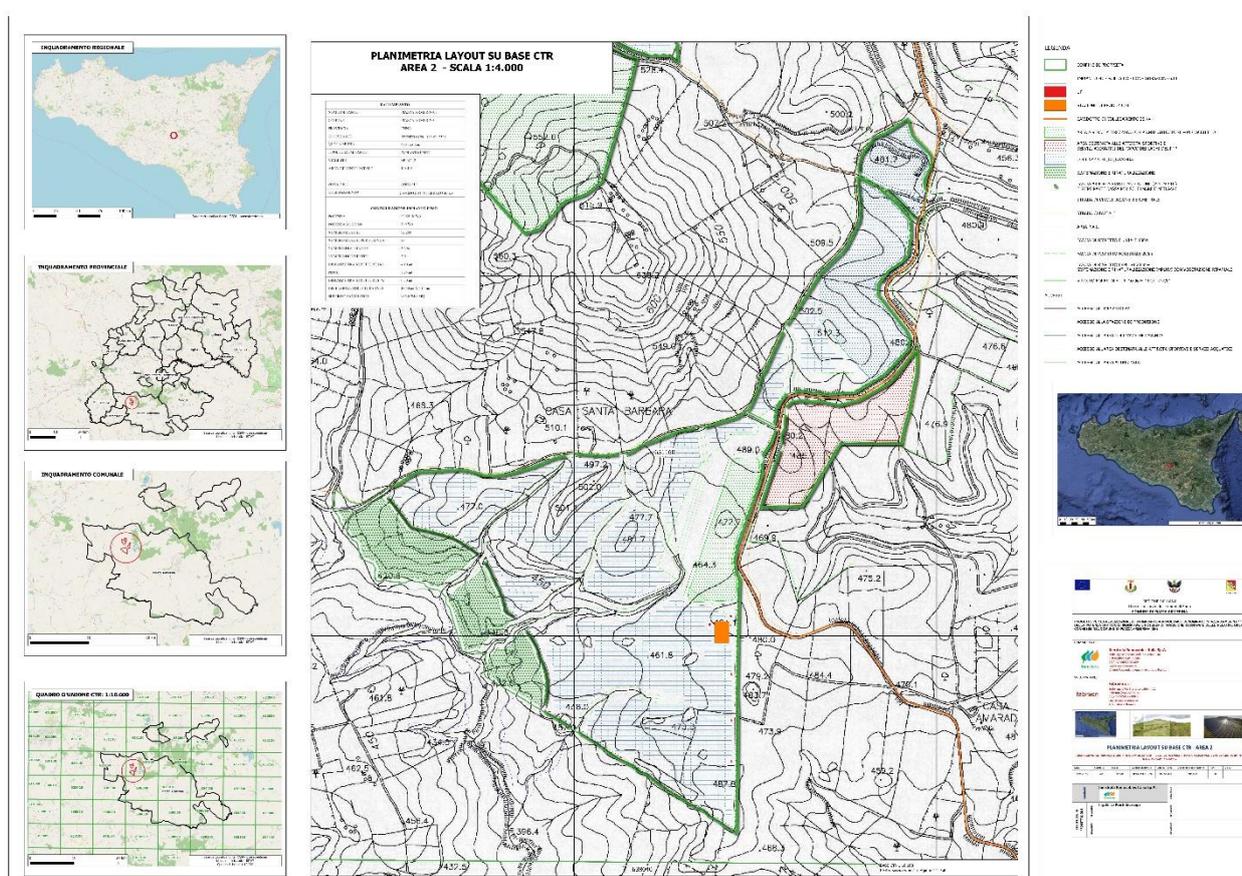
Planimetria layout – Area 2: Parco fotovoltaico area di intervento.
